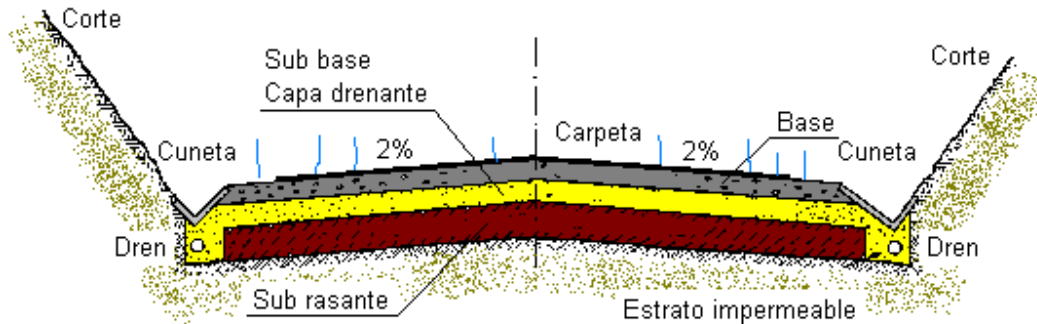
CAPA DRENANTE CON FILTRACIÓN POR EL PAVIMENTO
